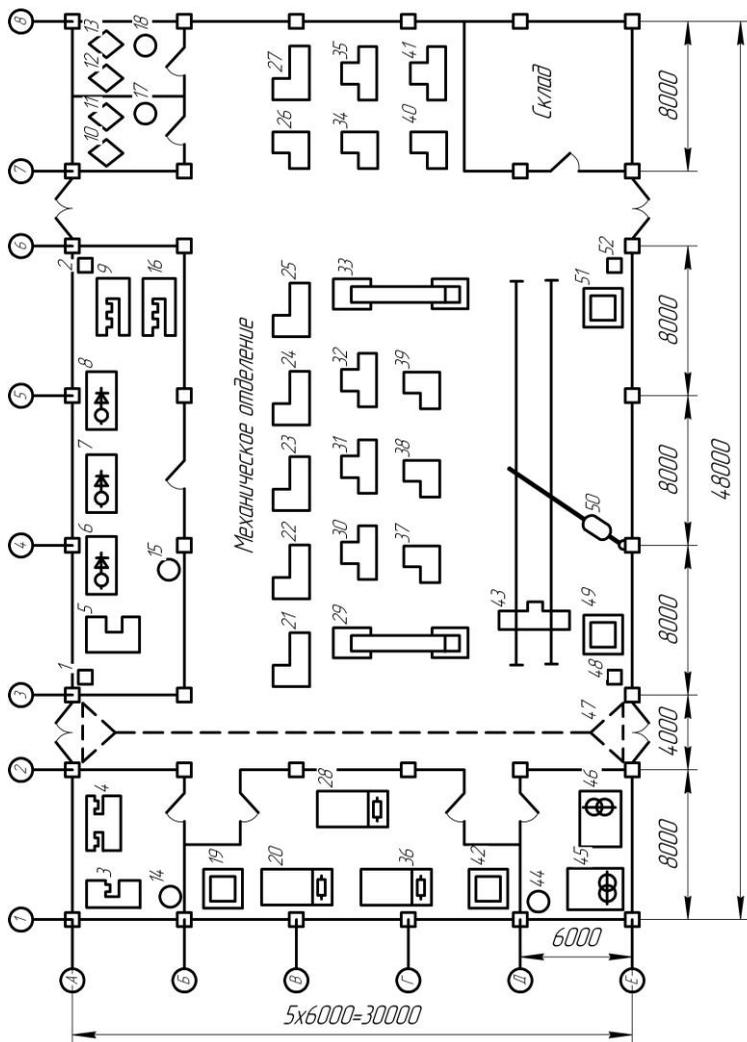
План расположения ЭО сварочного участка цеха
